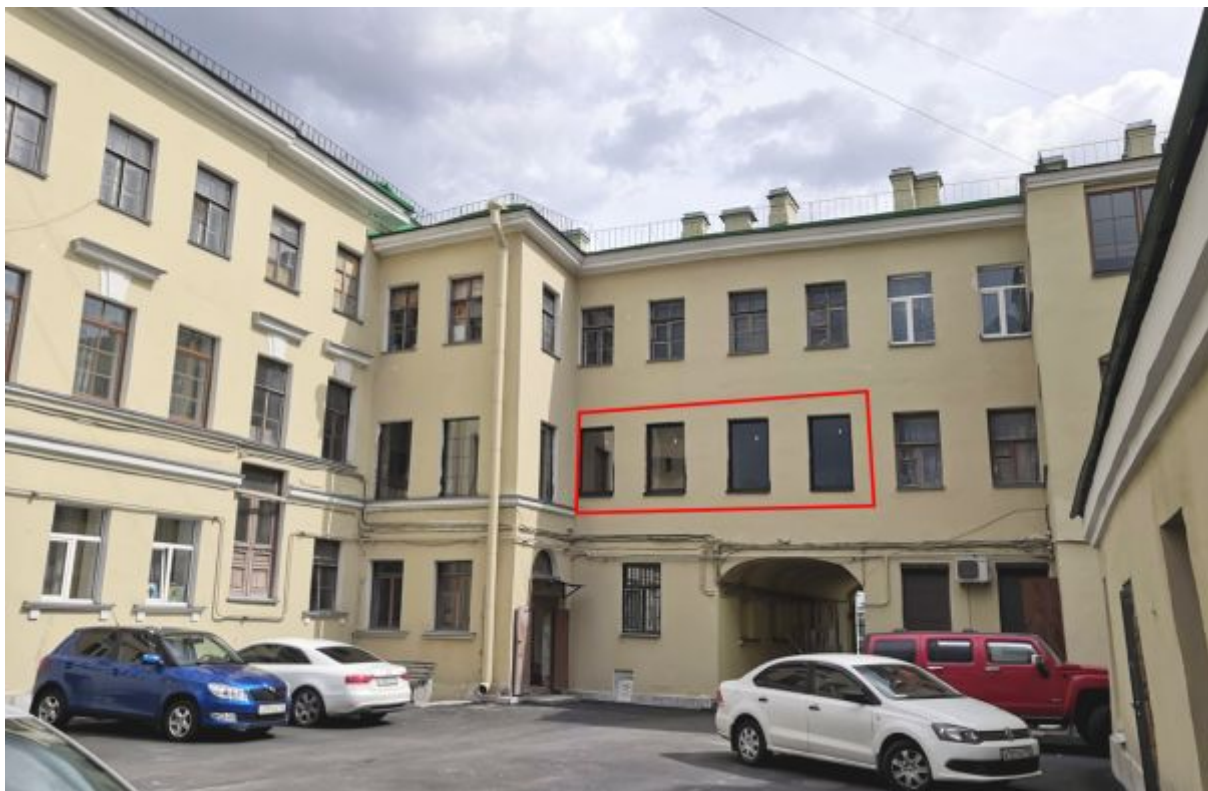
Дворовый фасад лицевого флигеля дома №28 по Синопской наб.
